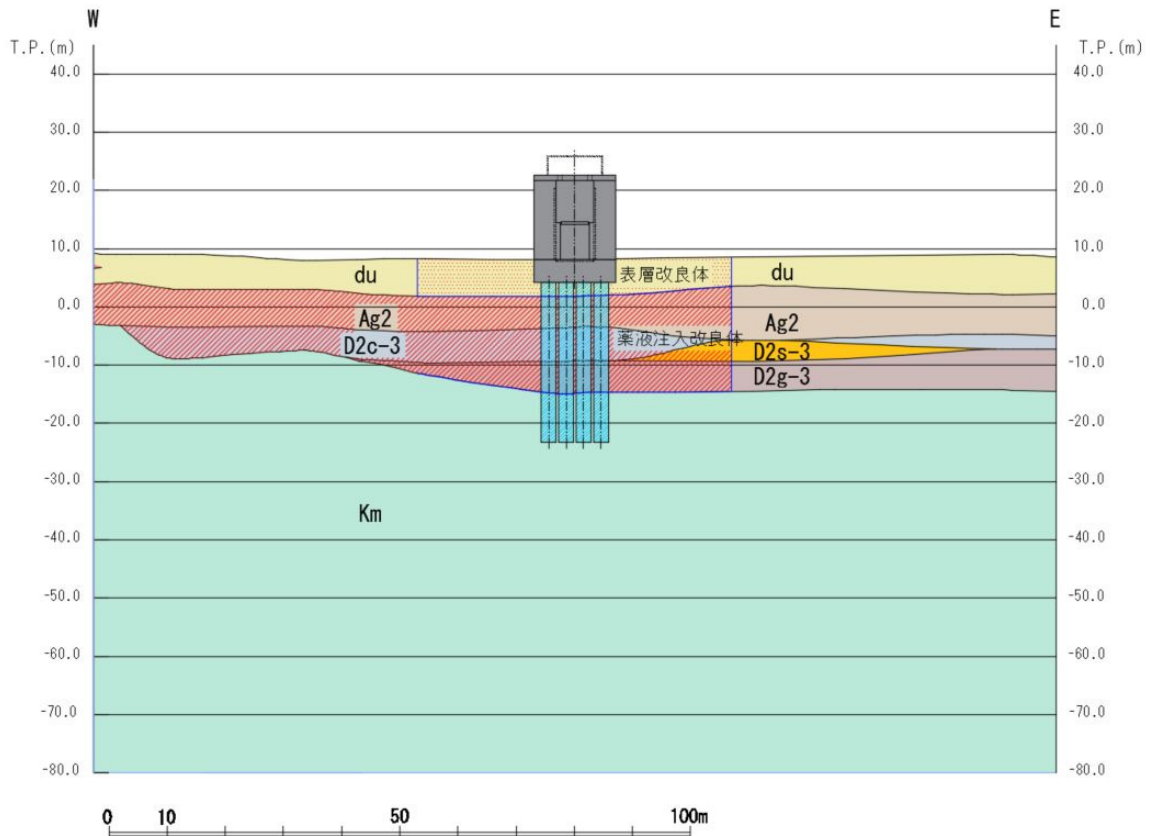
(2) 評価対象断面図 (B-B断面)
